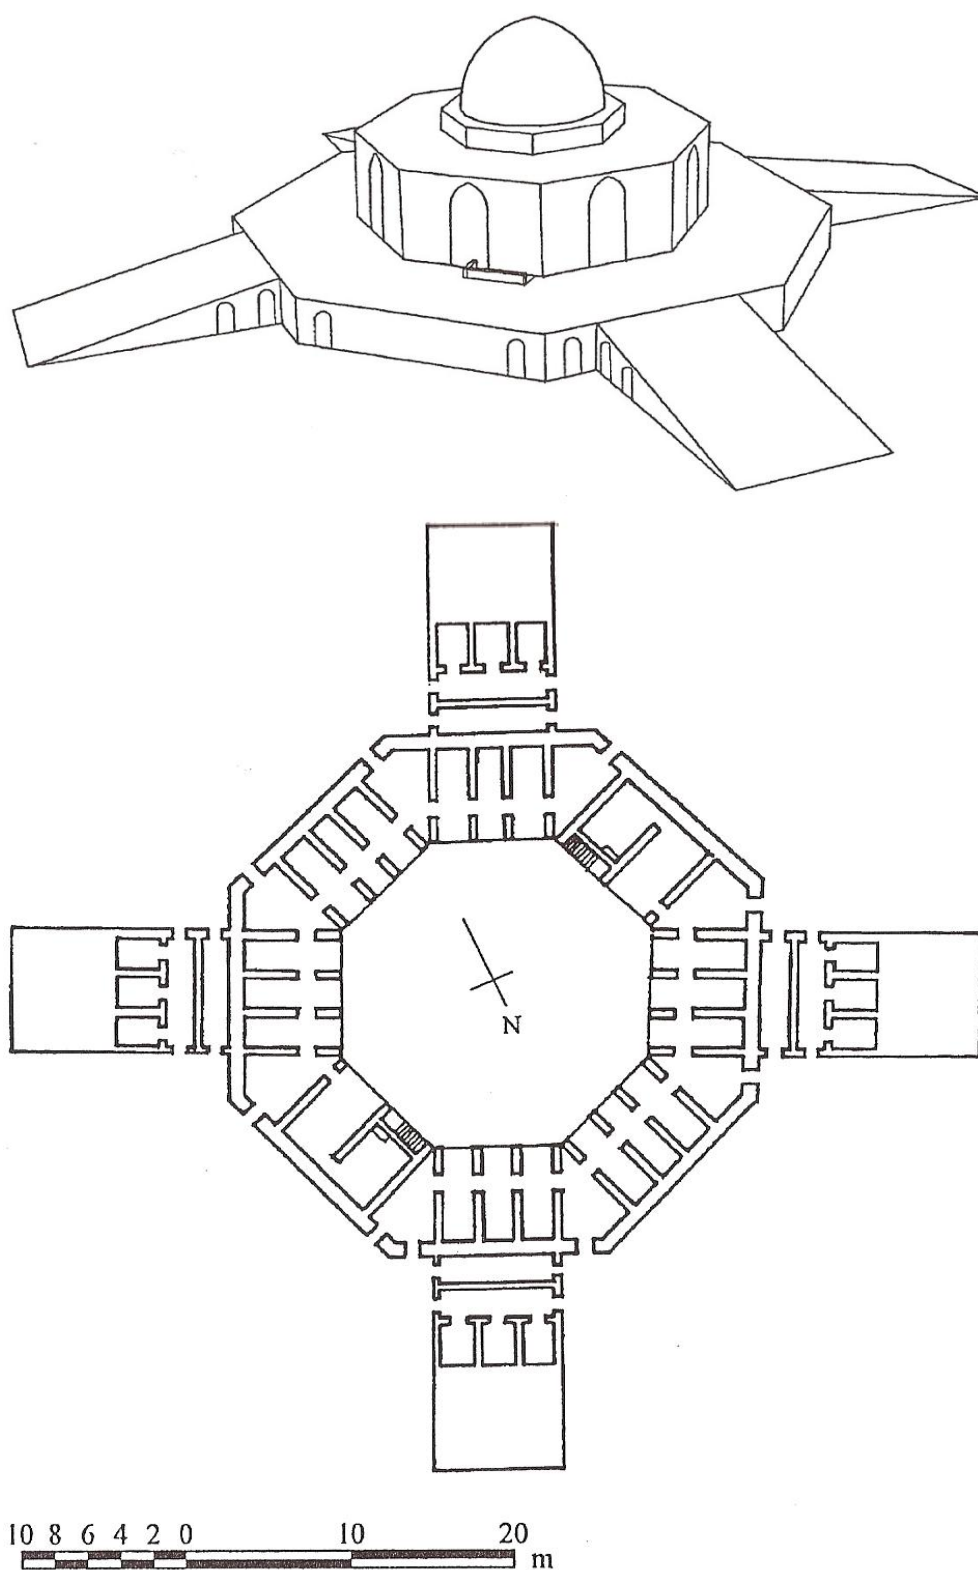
Rekonstruktion Aufriss und Grundriss, Qubbat as-Sulaibiyya, neue Befundlage nach 1973
